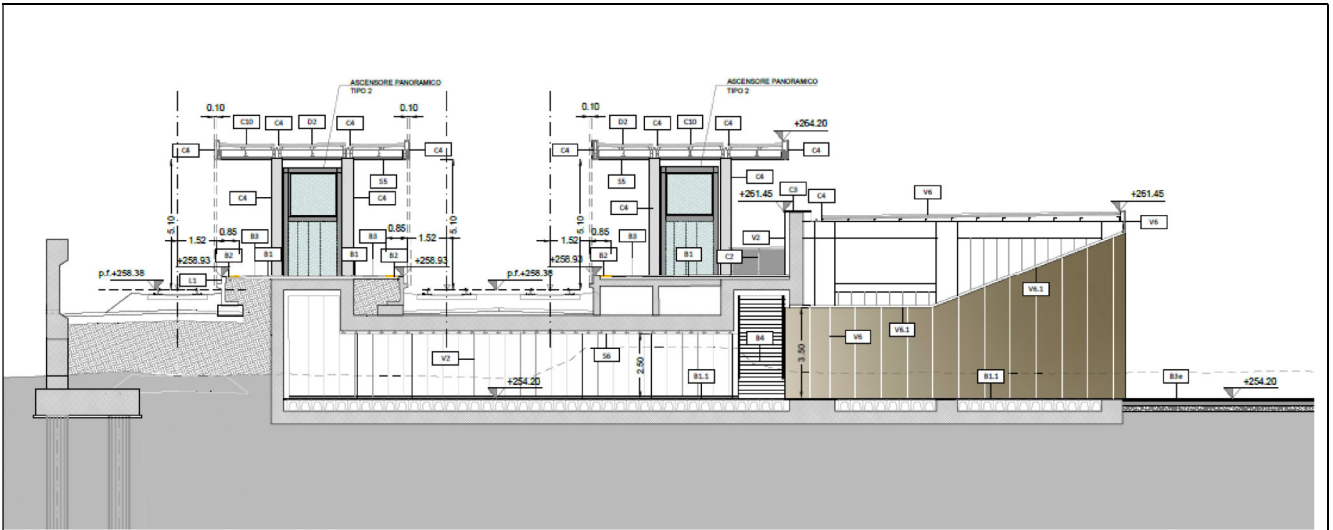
Stazione di Dittaino: Sezione trasversale in corrispondenza sottopasso
